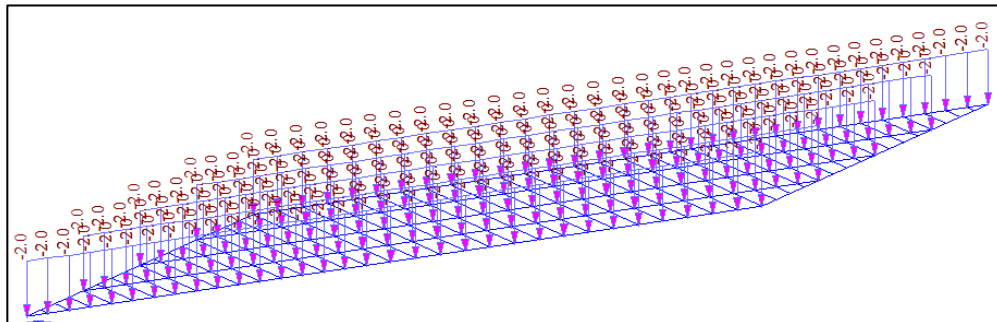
Sobrecarga distribuida a lo largo de las vigas longitudinales.
